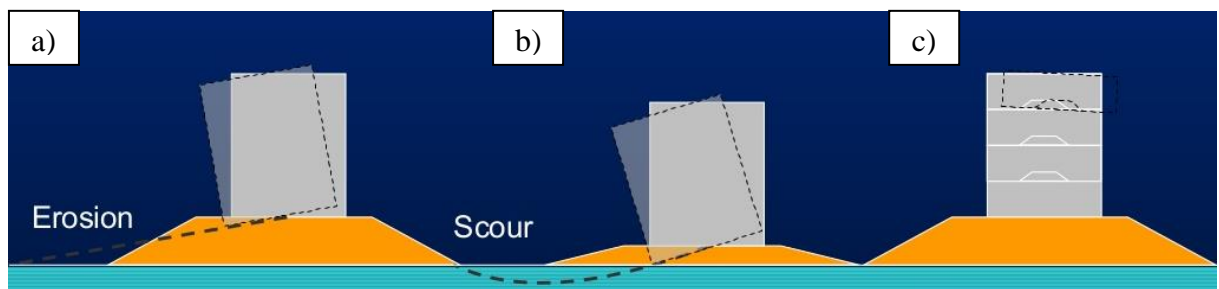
Falha de um quebra-mar vertical por: a) erosão da camada de fundação, b) erosão do fundo marinho e c) instabilidade parcial da estrutura
